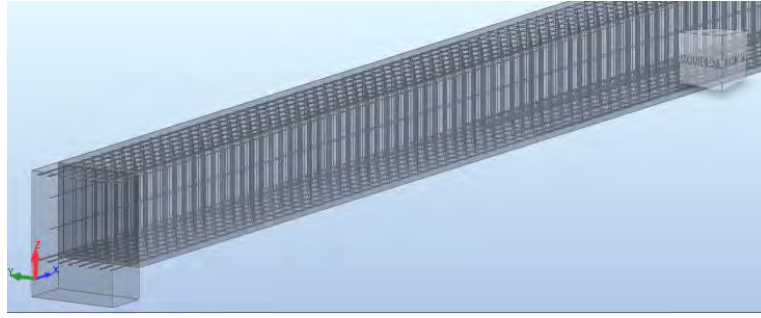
DETALLE DE ARMADURA DE LA VIGA
